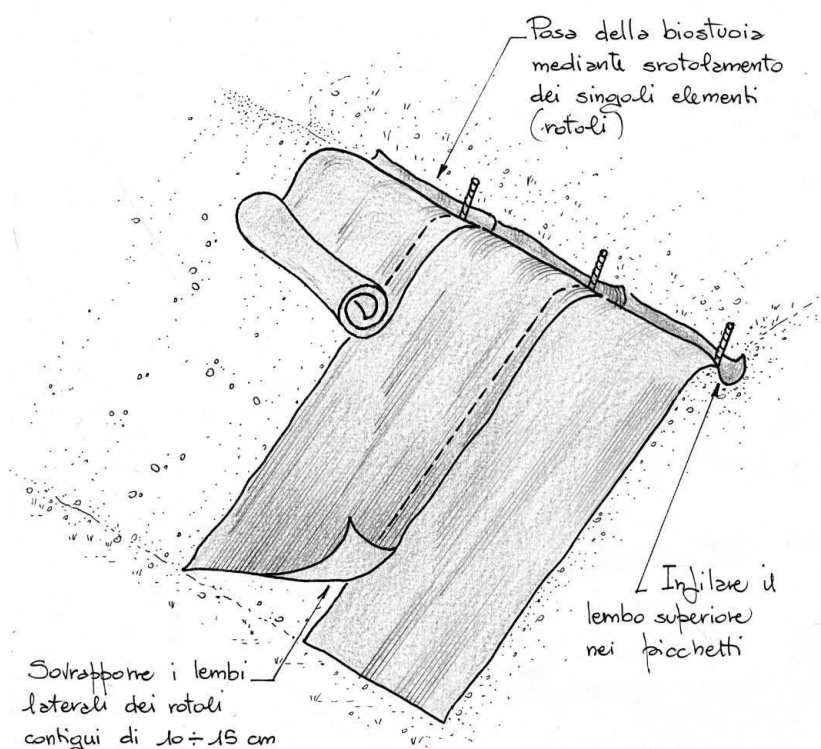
Schema di posa e fissaggio delle biostuoie con picchetti ad "U"
